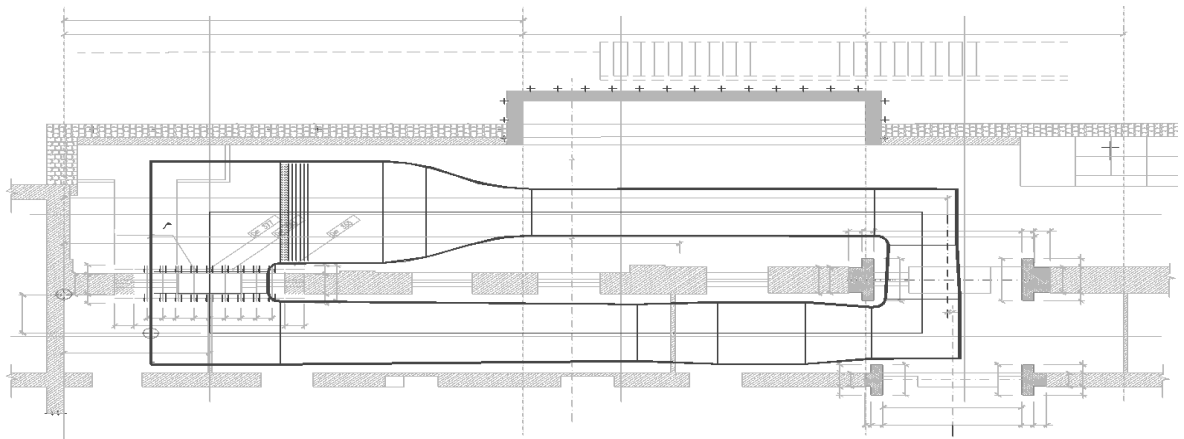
Planimetria dell'impianto e sua collocazione all'interno del laboratorio.
